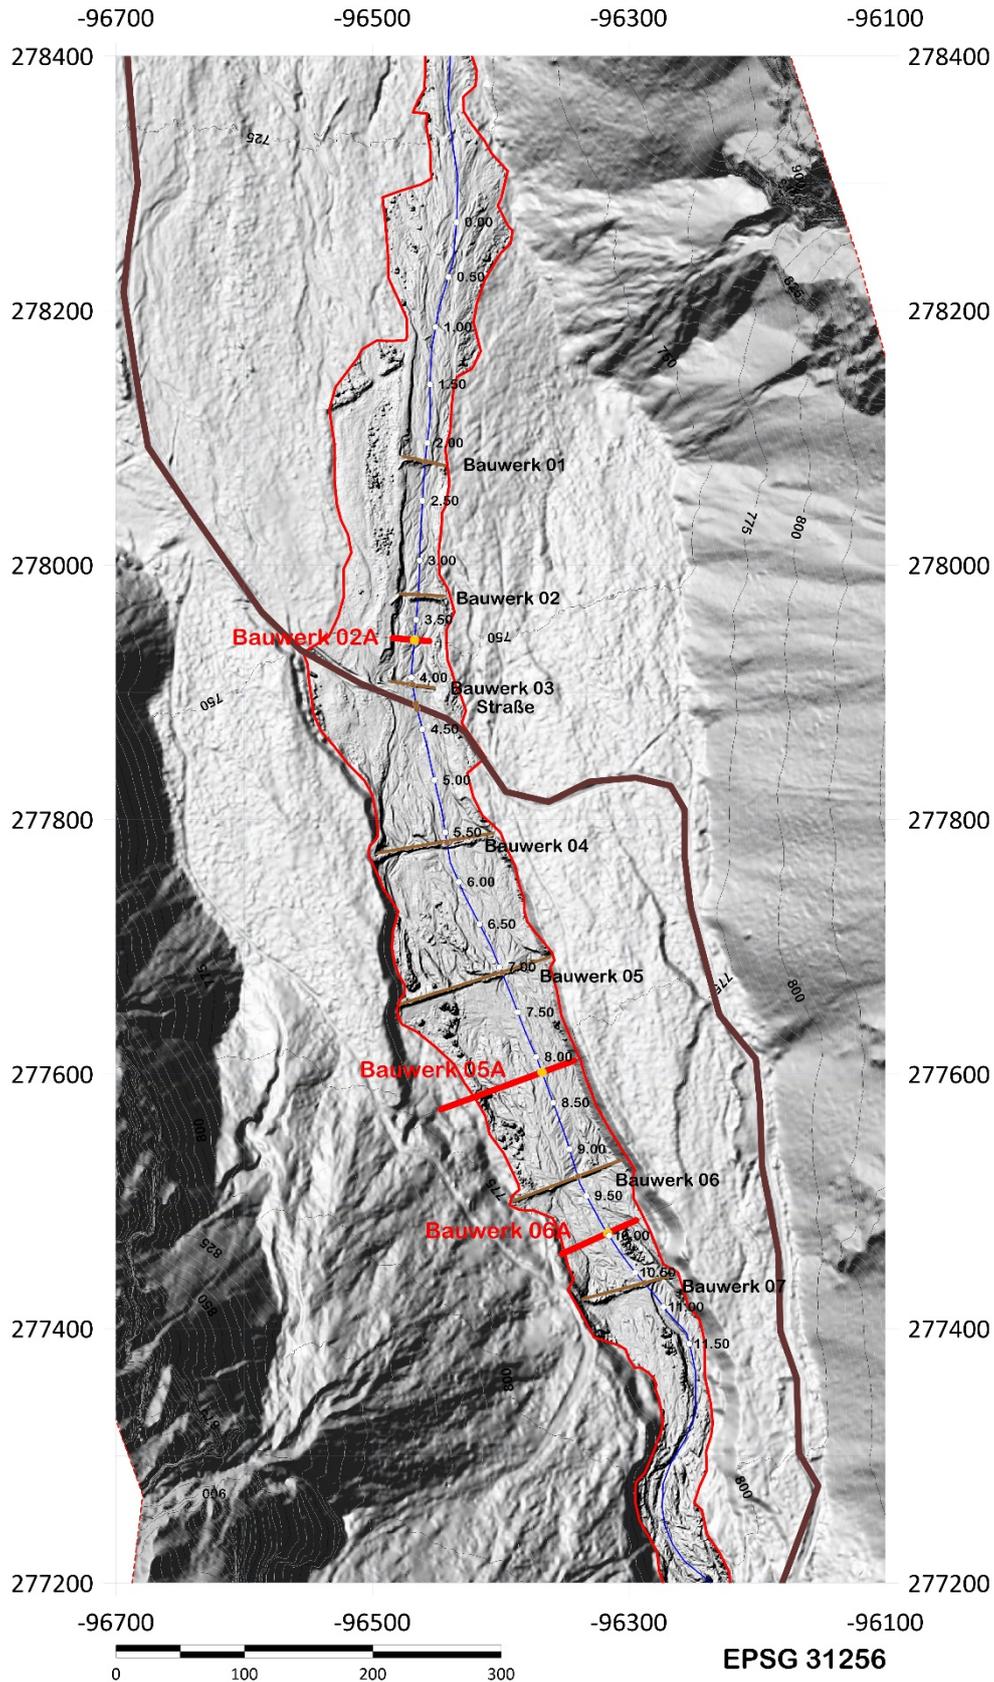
Lageplan mit den zusätzlichen stabilisierenden Bauwerken
